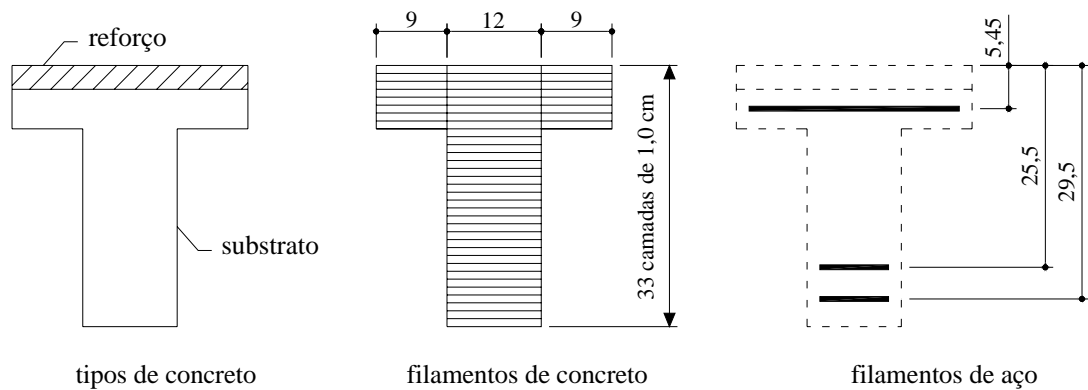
Discretização da seção transversal (dimensões em cm)
